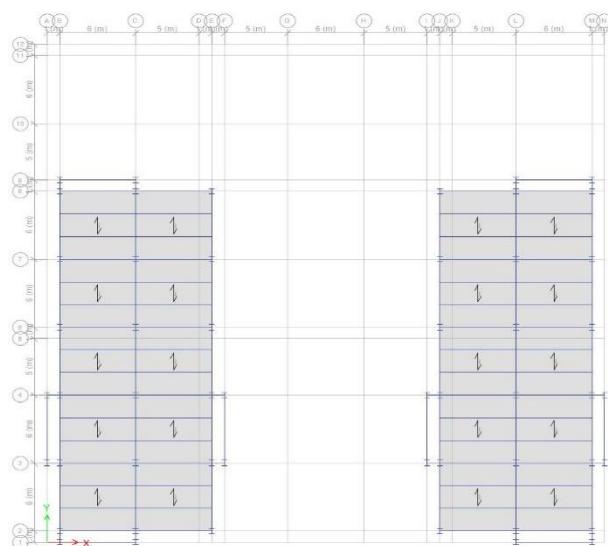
Denah lantai 4-6 Model 1 (Breising di sudut-sudut bangunan)
